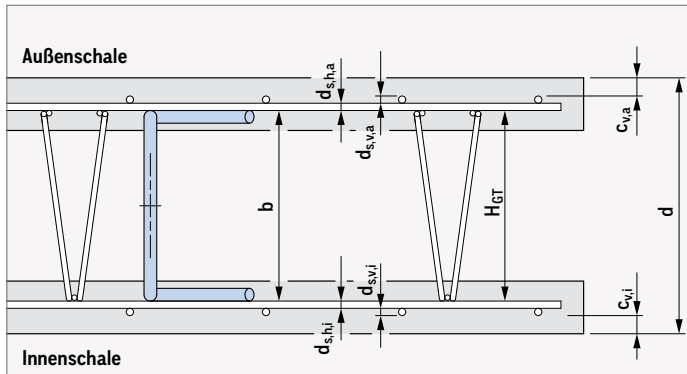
Horizontalbewehrung liegt in den Wandschalen jeweils innen
